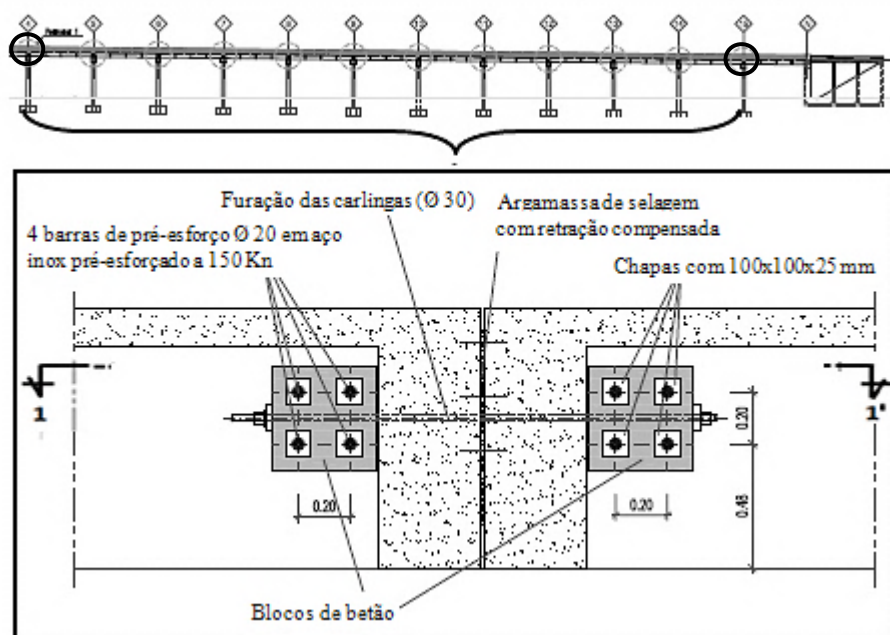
Pormenor da ligação das vigas longitudinais (adaptado de Brisa, 2002b).
